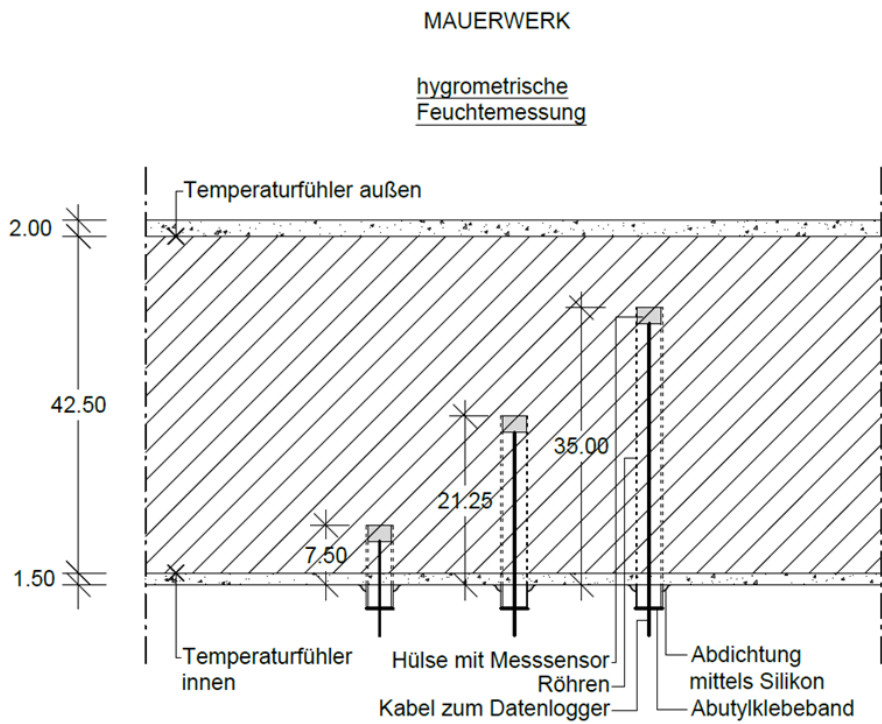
Übersicht Querschnitt Mauerwerksaußenwand mit Messtechnik im Bauteil, Jessica Nagl
